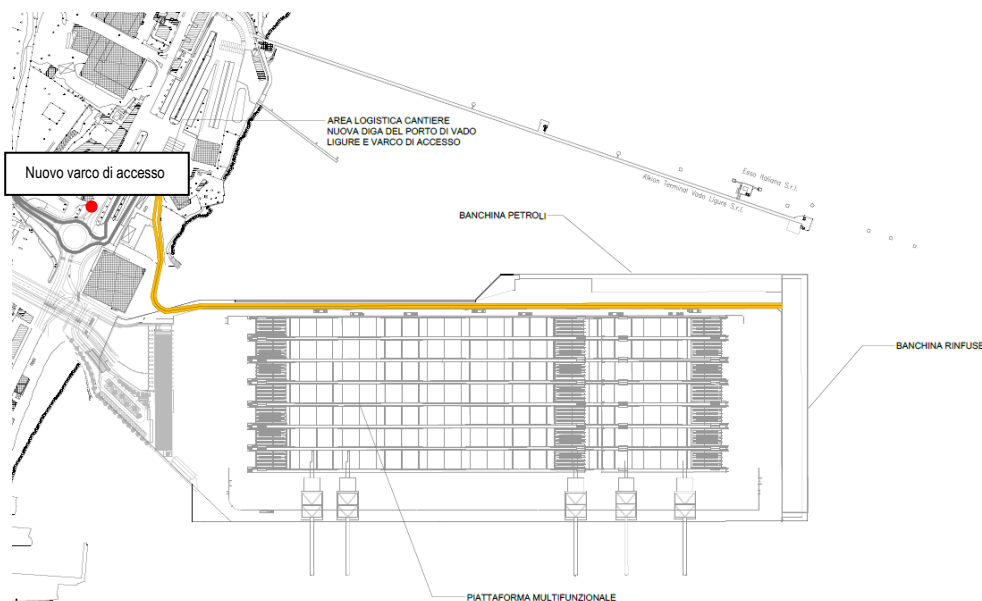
Area Prefabbricazione di Vado Ligure – Estratto tavola P3062\_E-GE-G-V102 - L'accesso principale dal cantiere verrà spostato come da prescrizioni del Comune di Vado Ligure
